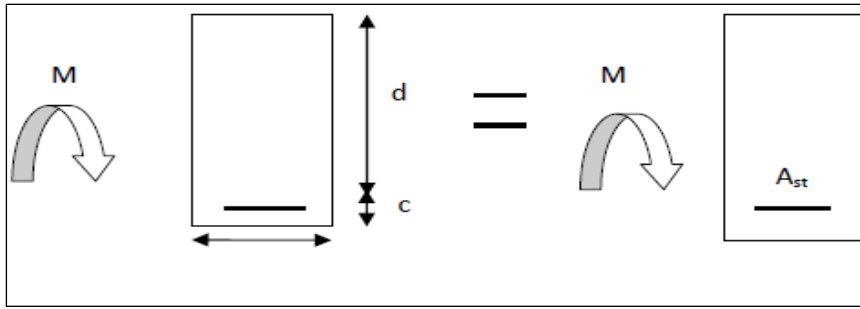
Schéma de Ferraillage des poutres simplement armée
